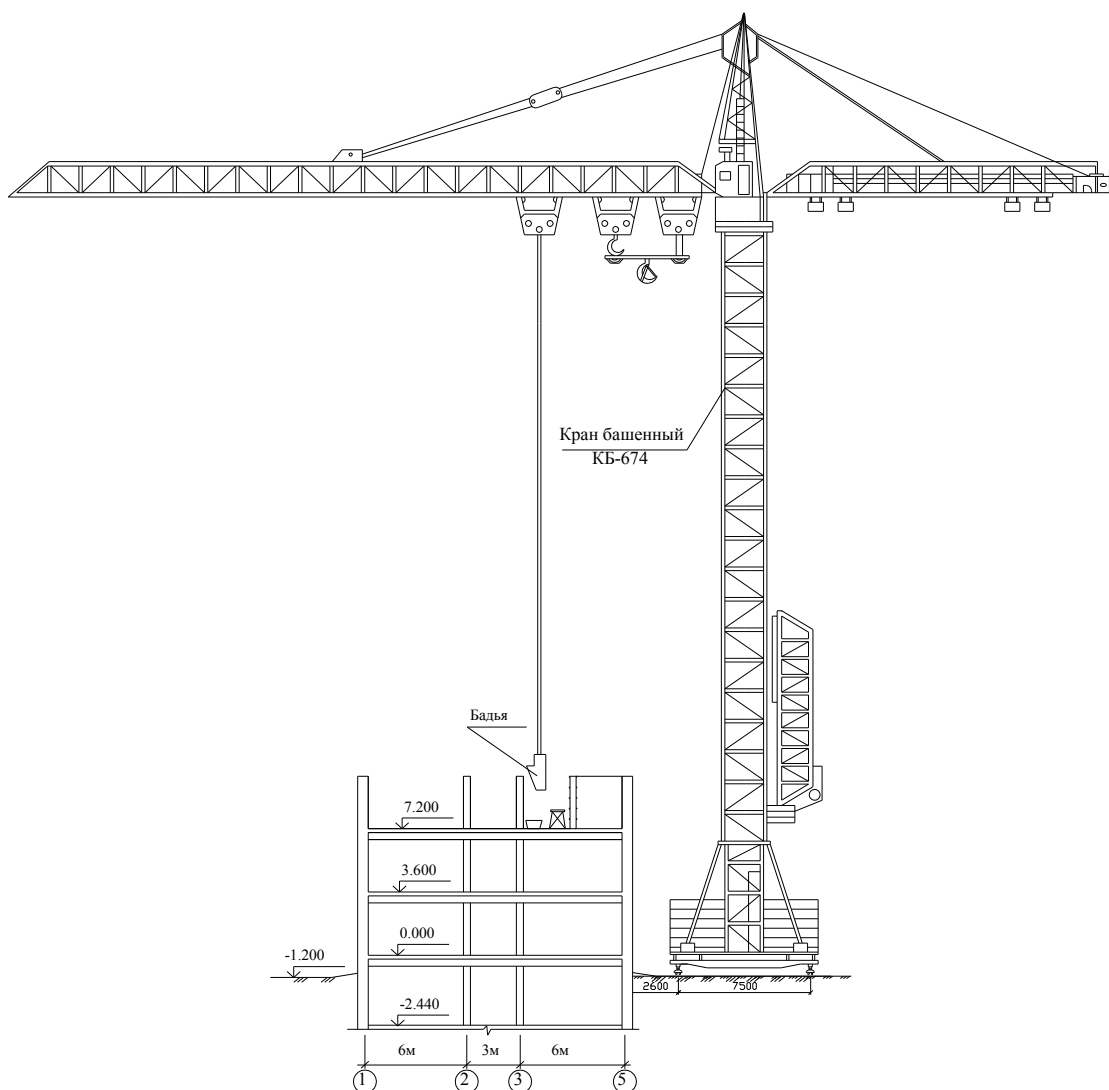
Схема подачи краном бетонной смеси в бадье
